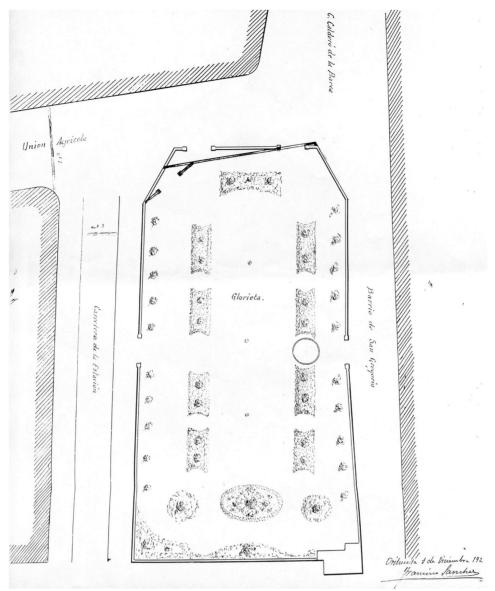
Plano de la Glorieta (AMO, G 69/3)
